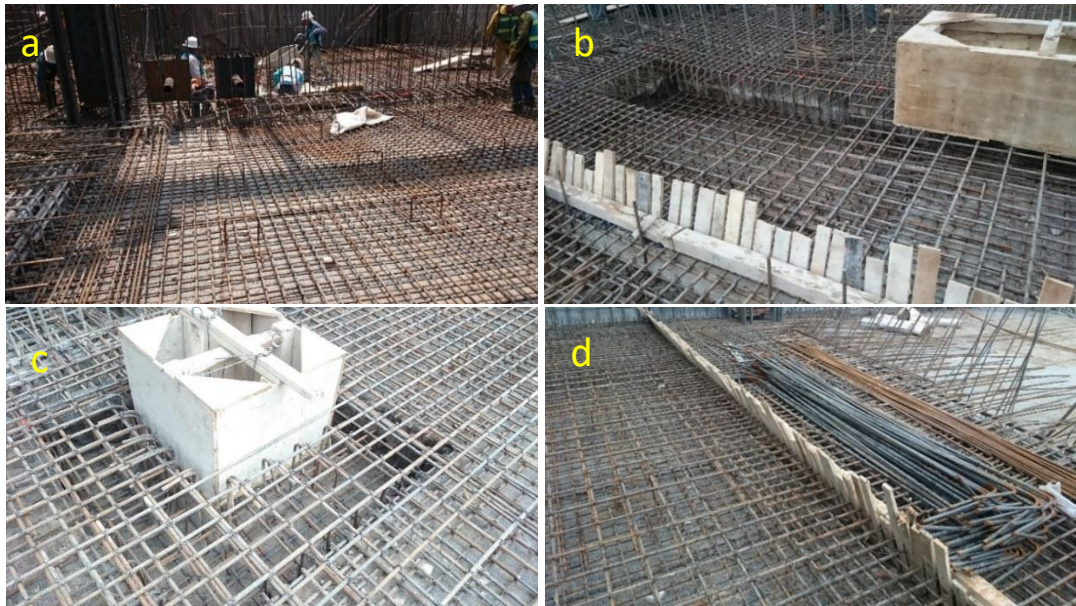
Armado de acero y cimbra de la losa de cimentación.
